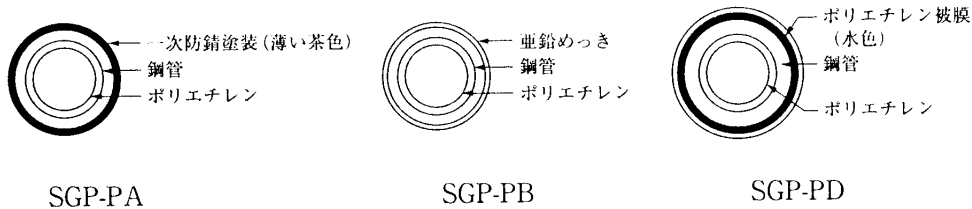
ポリエチレン粉体ライニング鋼管断面図
